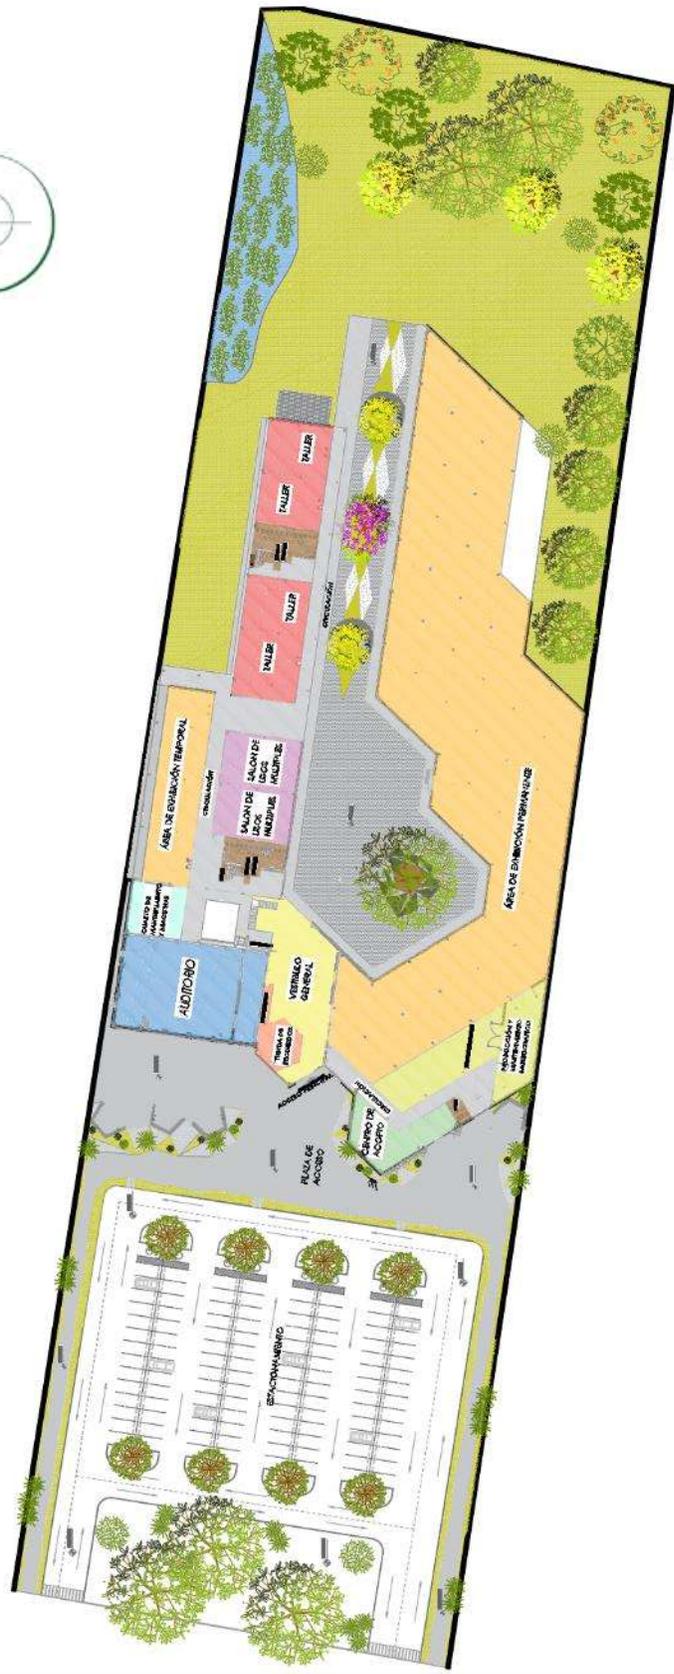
| Zonificación de la planta de conjunto FUENTE I Creado por SGGG
